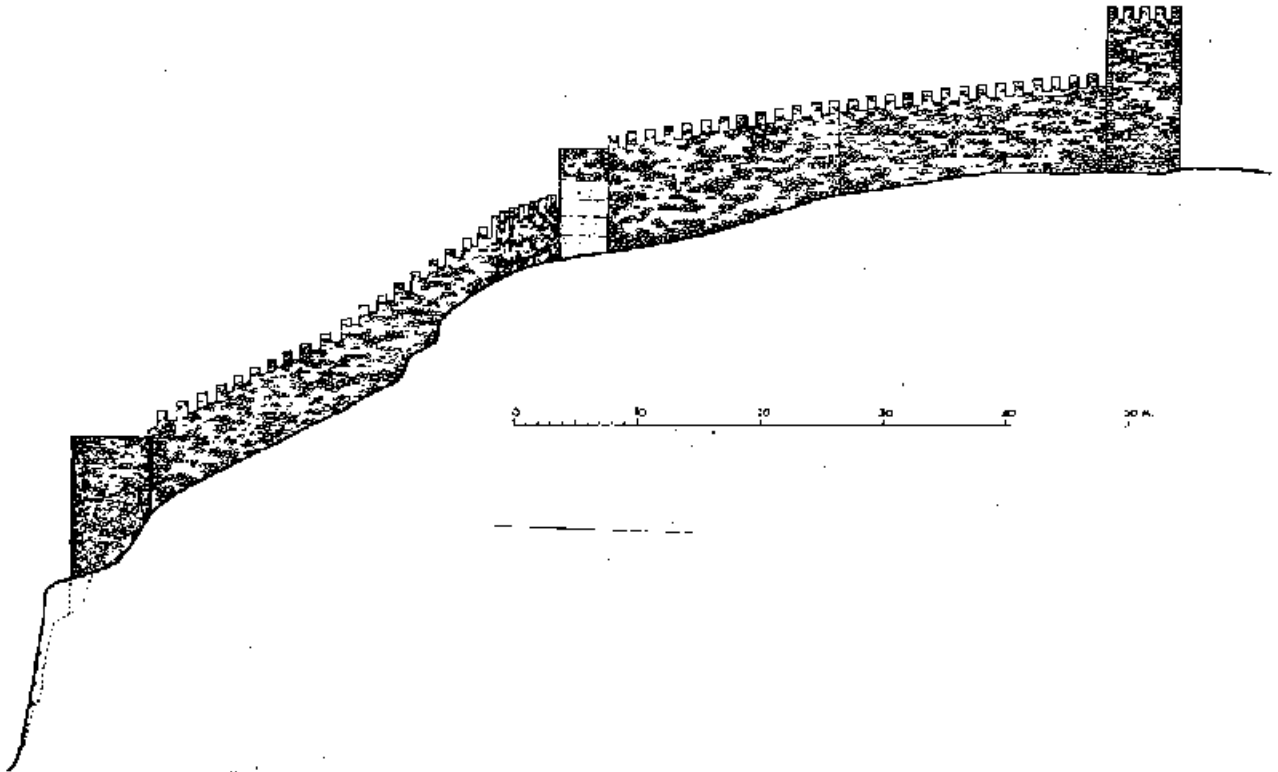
Alzado norte del recinto exterior de Albarracín.
